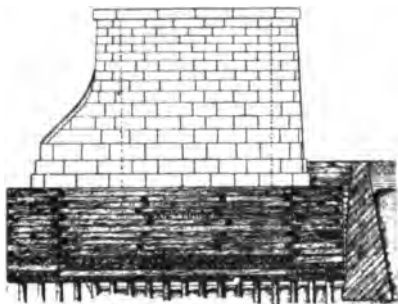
Pile du Pont de Fort Madison (d'après l'Engineering News).
